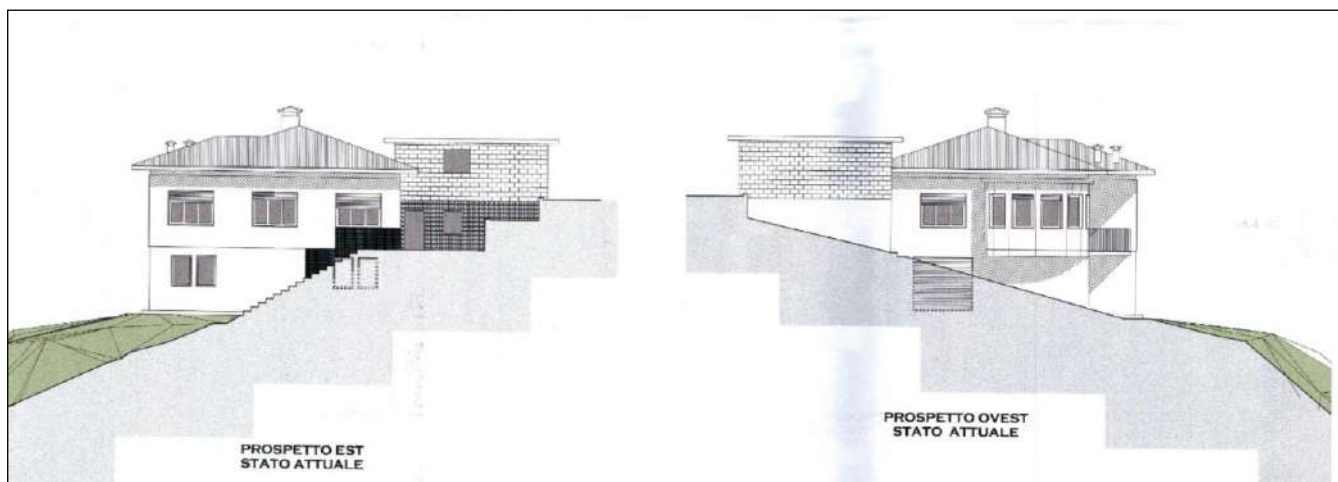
d. Stato approvato: Prospetti Est-Ovest Permesso di Costruire PC07/0063 del 25.10.2007.
